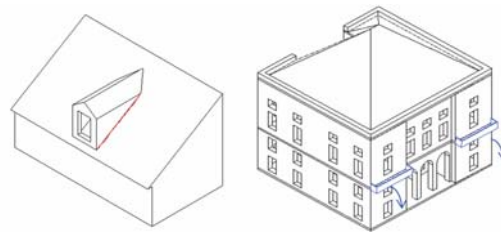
Schadenstyp P18: Schäden an vorspringenden/ausragenden Elementen
